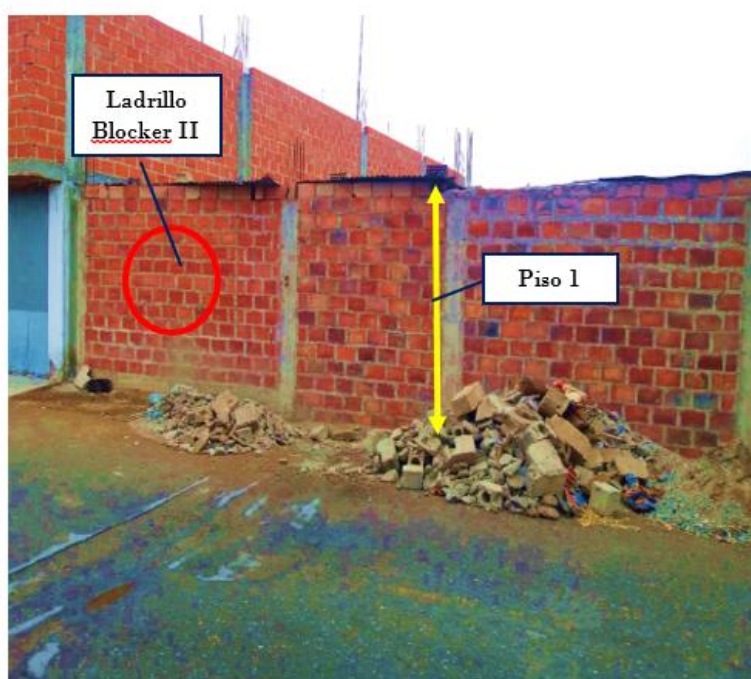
Vista de vivienda 11. Vivienda construida con Blocker II, presenta 1 piso con diafragma flexible.
